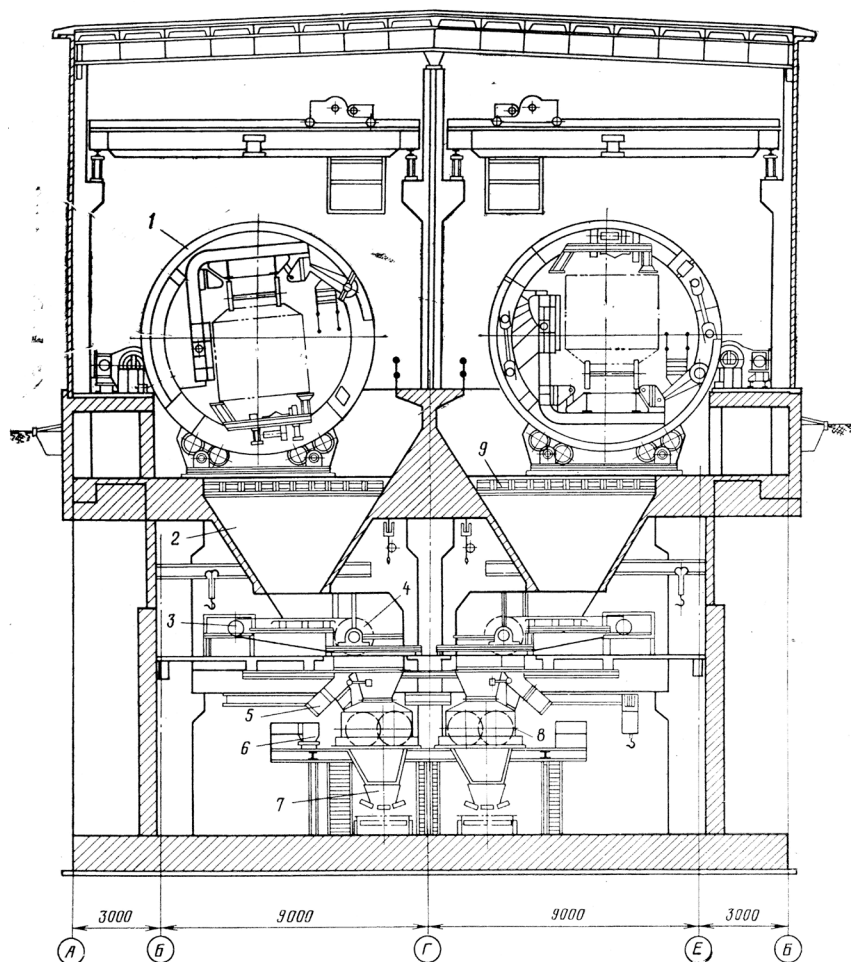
Разгрузочное устройство с двумя роторными вагонопрокидывателями:
